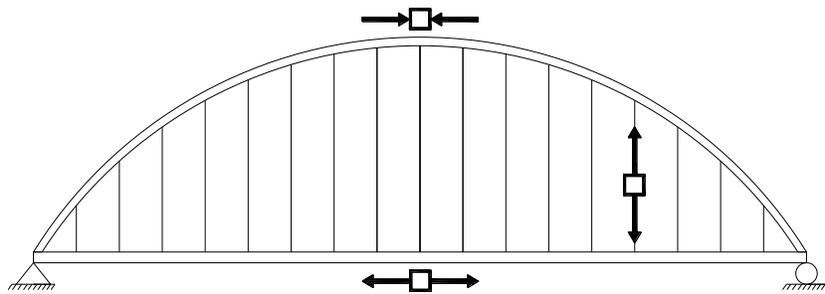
Esfuerzos actuantes sobre un puente en arco.
